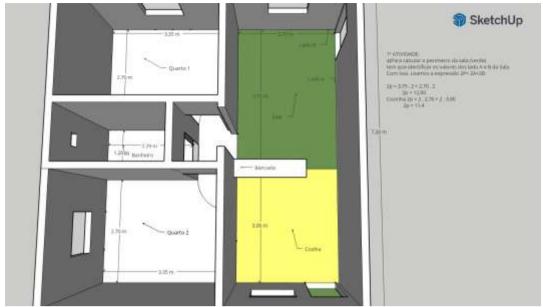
Planta baixa das casas habitacionais Fonte: Autores
